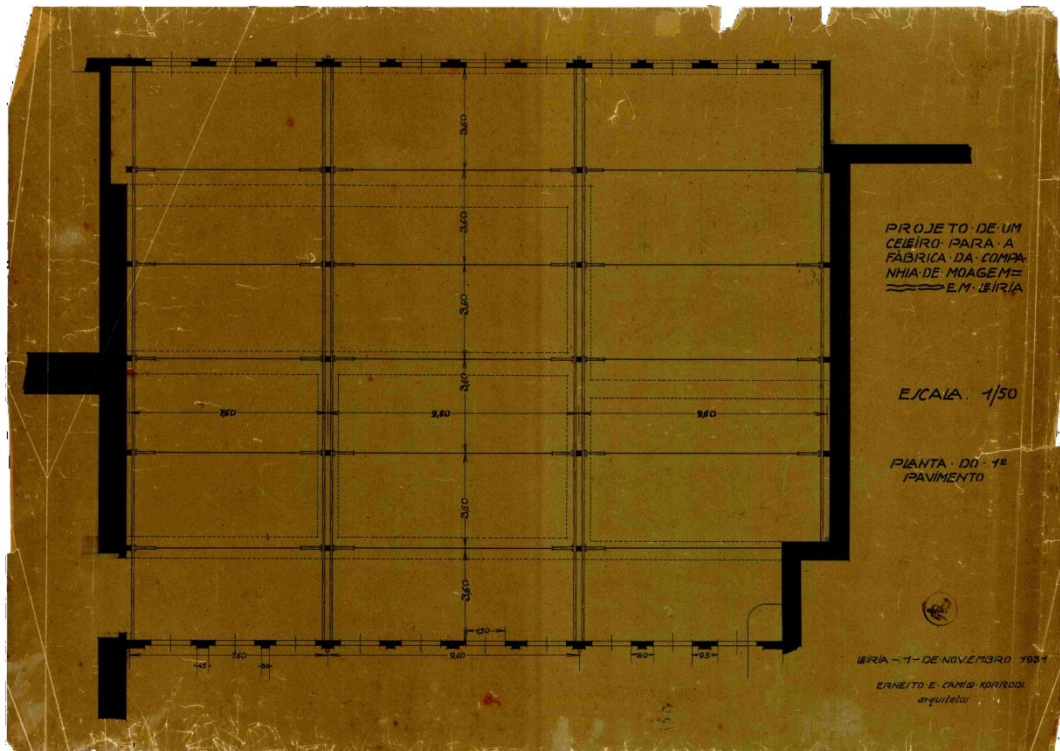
Planta do primeiro piso do celeiro construído posteriormente à transformação em moagem.
